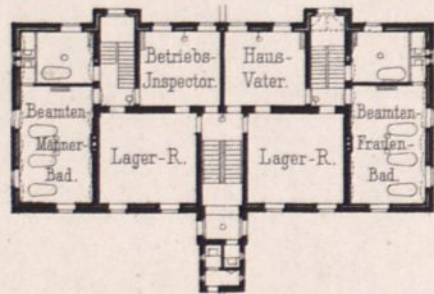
Oekonomie-Gebäude. Grundriss des Erdgeschosses.
